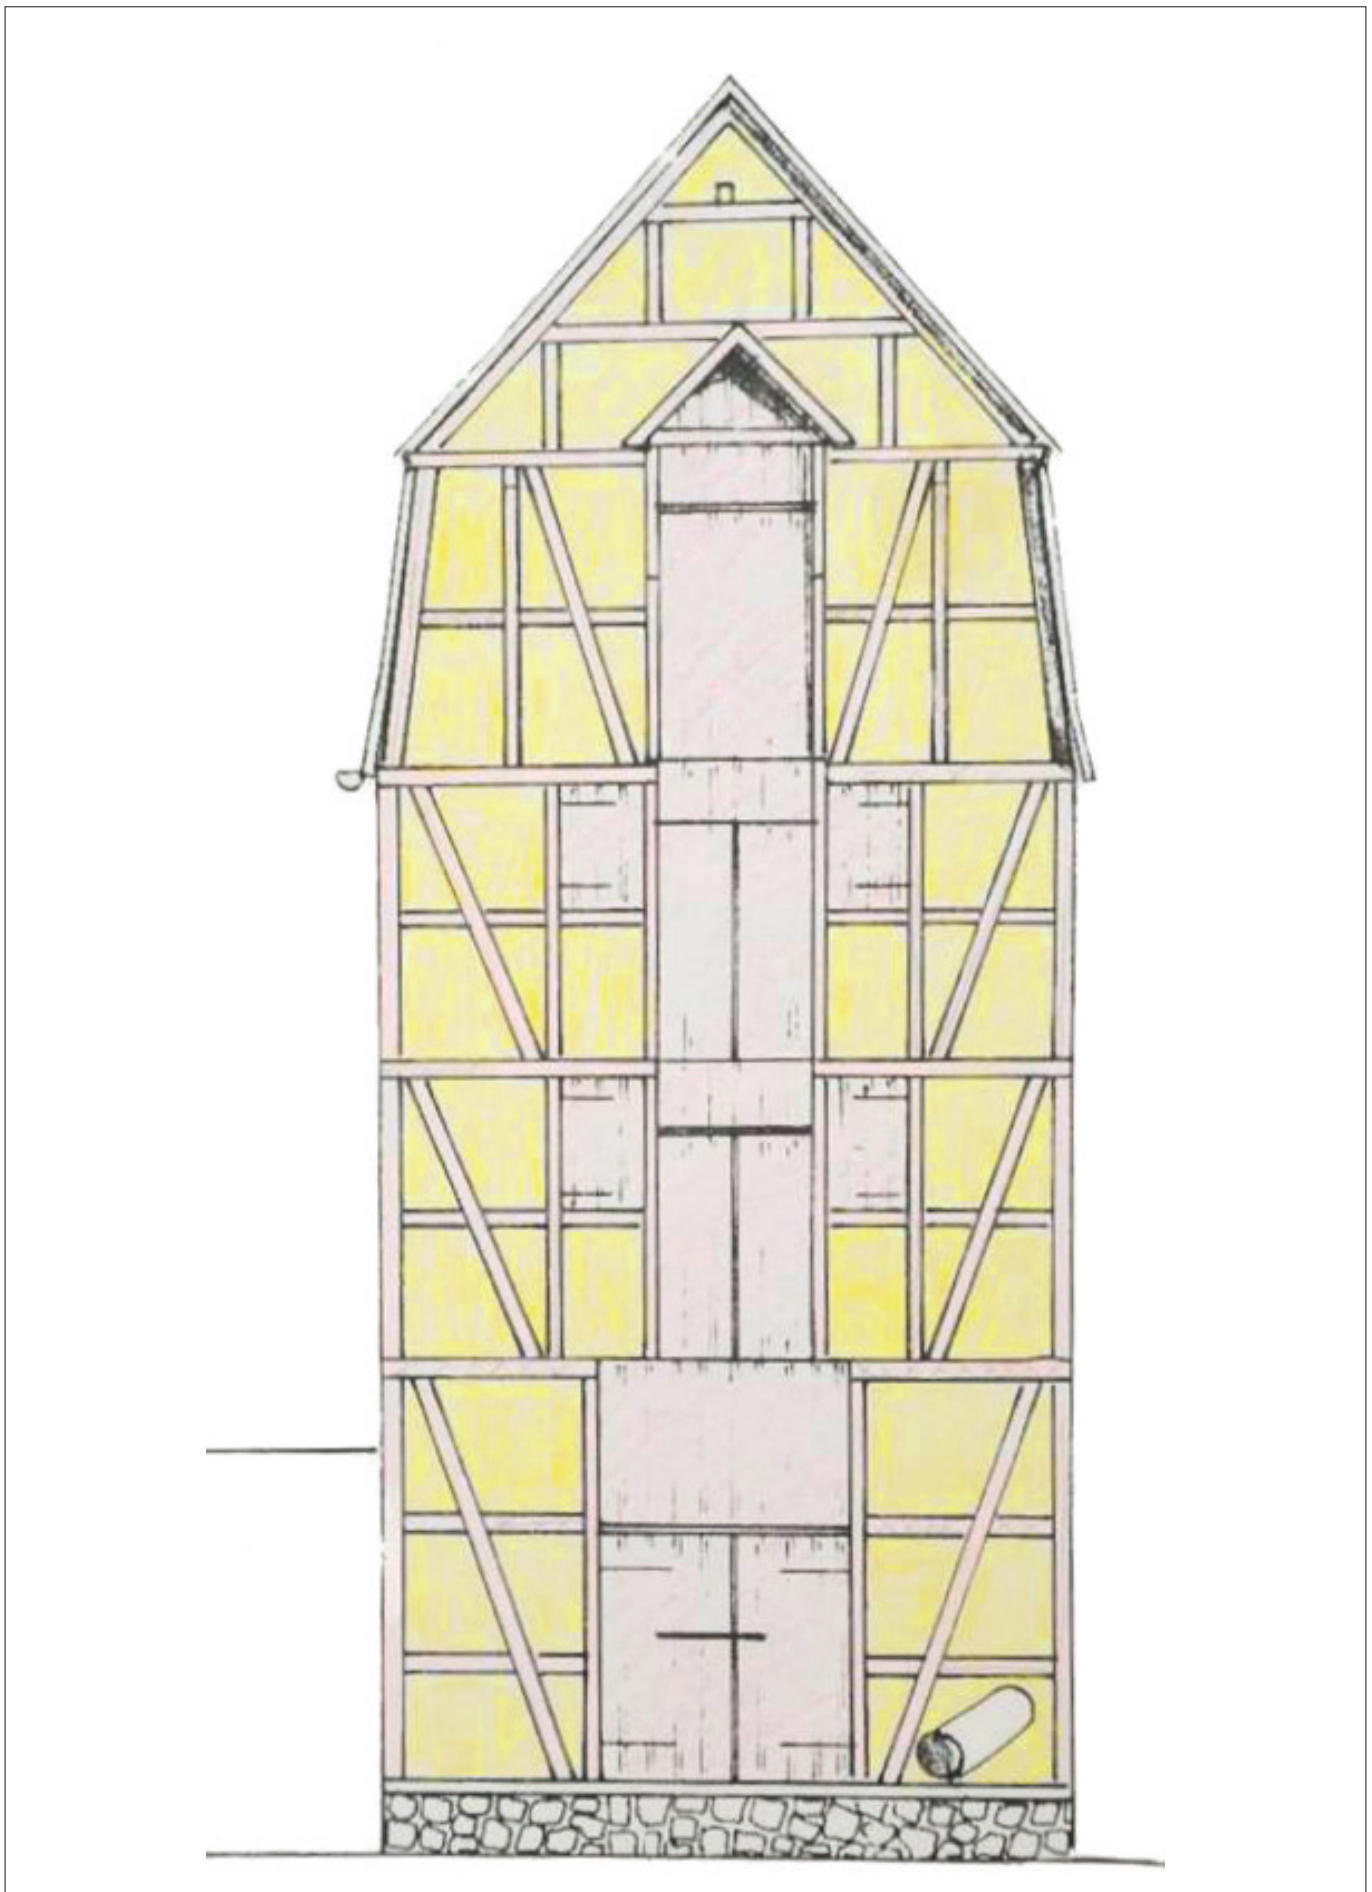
Ansicht Südfassade, Ausfachungen mit Baualterskartierung
